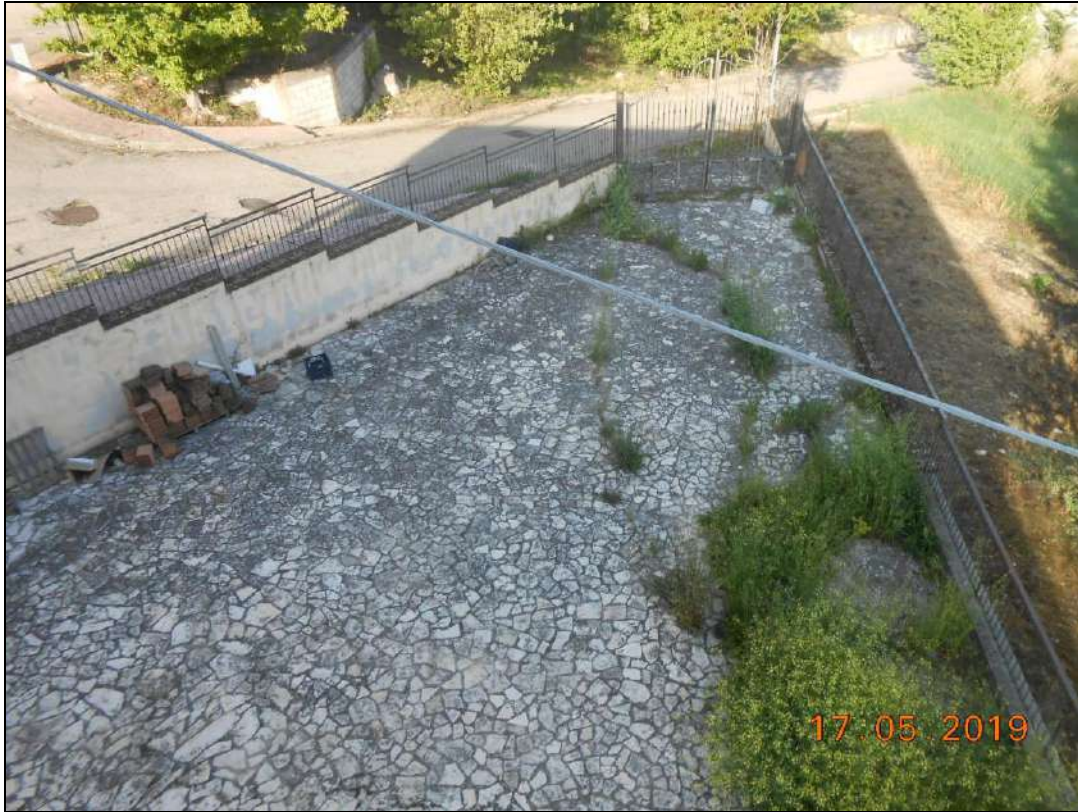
Vista della porzione dell'immobile insistente sulla p.lla 1011, non oggetto di pignoramento.
